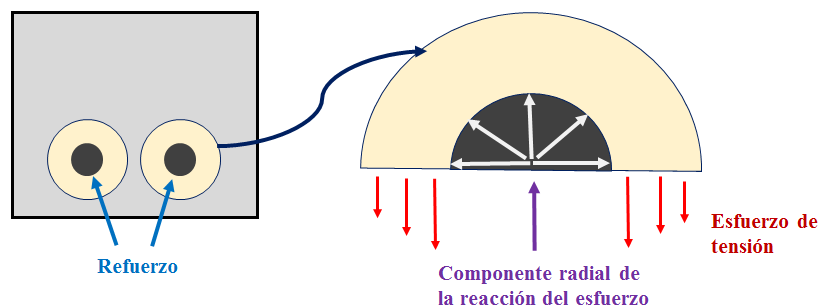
Fuerzas que actúan entre las barras corrugadas y el concreto.
